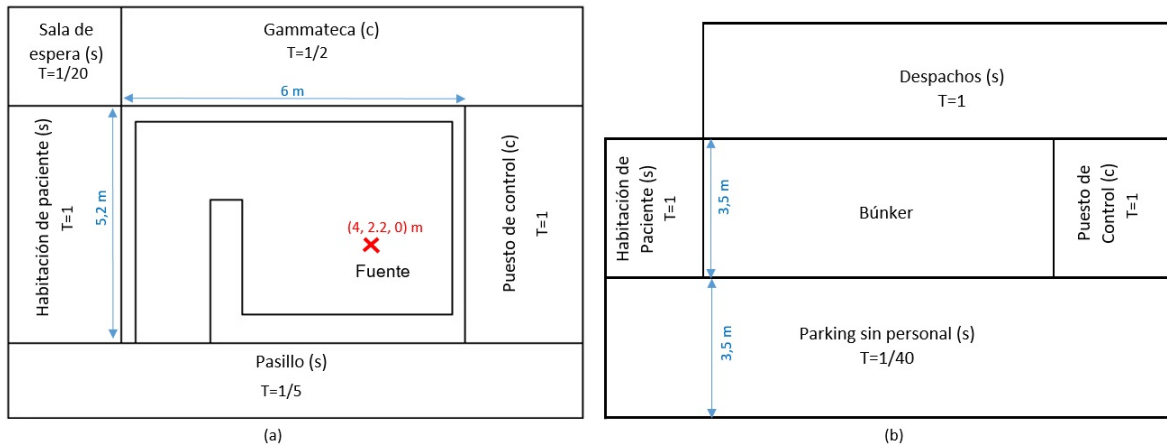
Sala de tratamiento sobre la que se ha realizado el ejemplo de esta sección con sus dimensiones y la posición de la fuente. (a) planta, plano x-y (b) alzado, plano x-z.
